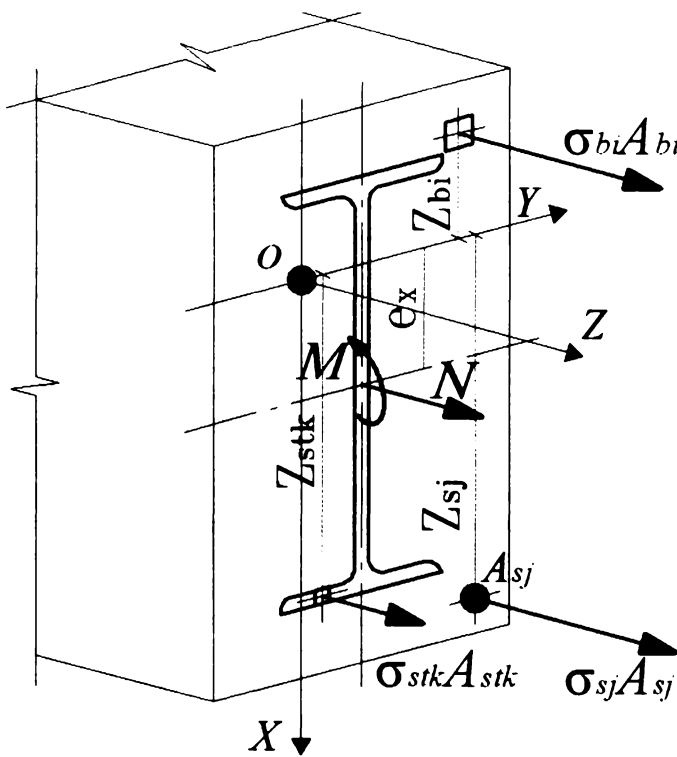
Расчетная схема нормального сечения сталежелезобетонного перекрытия
